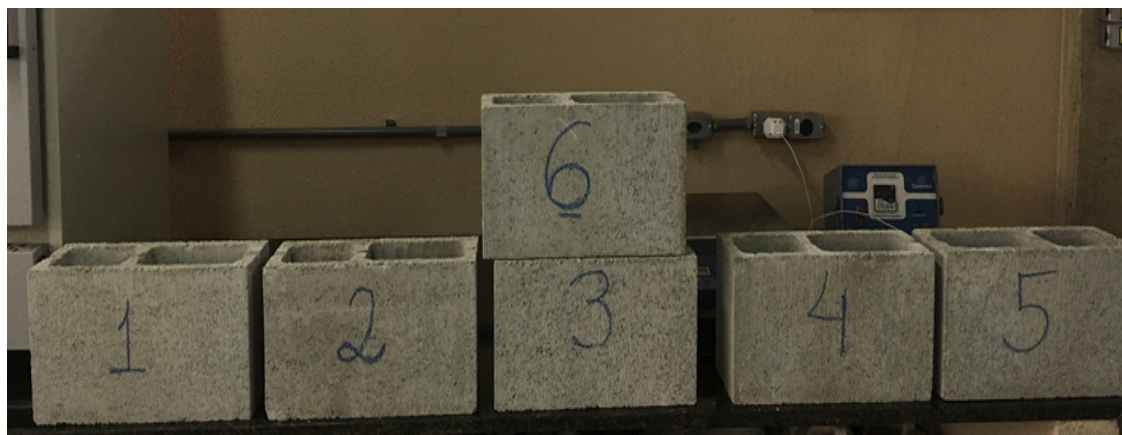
Blocos de concreto estruturais utilizados na pesquisa
